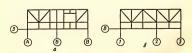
Схемы каркасов наружных стен вдоль осей 3(а) и В(б)
